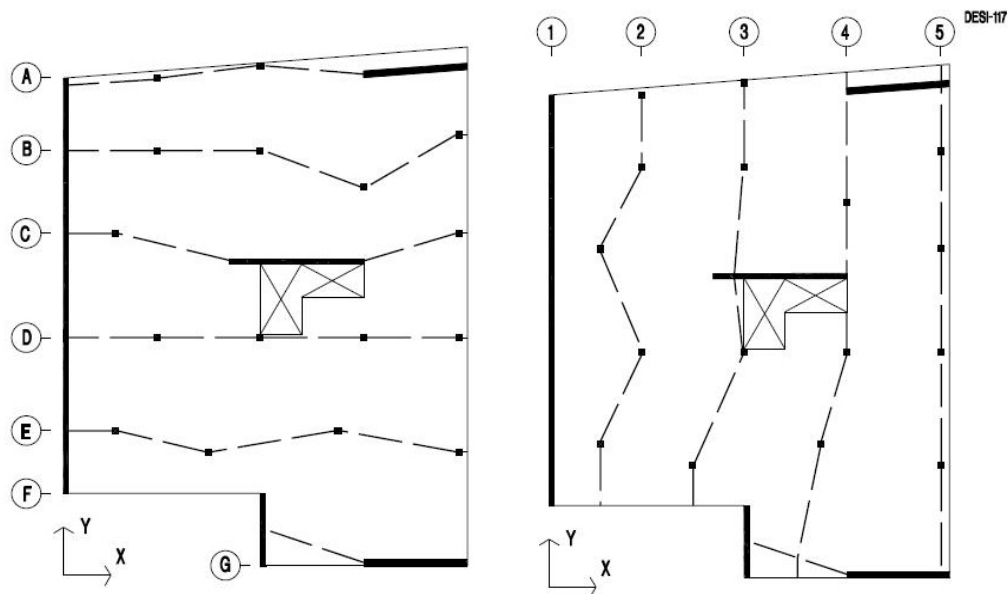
Pianta della piastra studiata, con indicazione degli spostamenti (*Best practice guide for in-situ concrete frame buildings* by British Cement Association)
